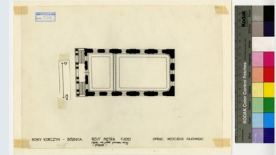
Grundriss Erdgeschoss 1987
